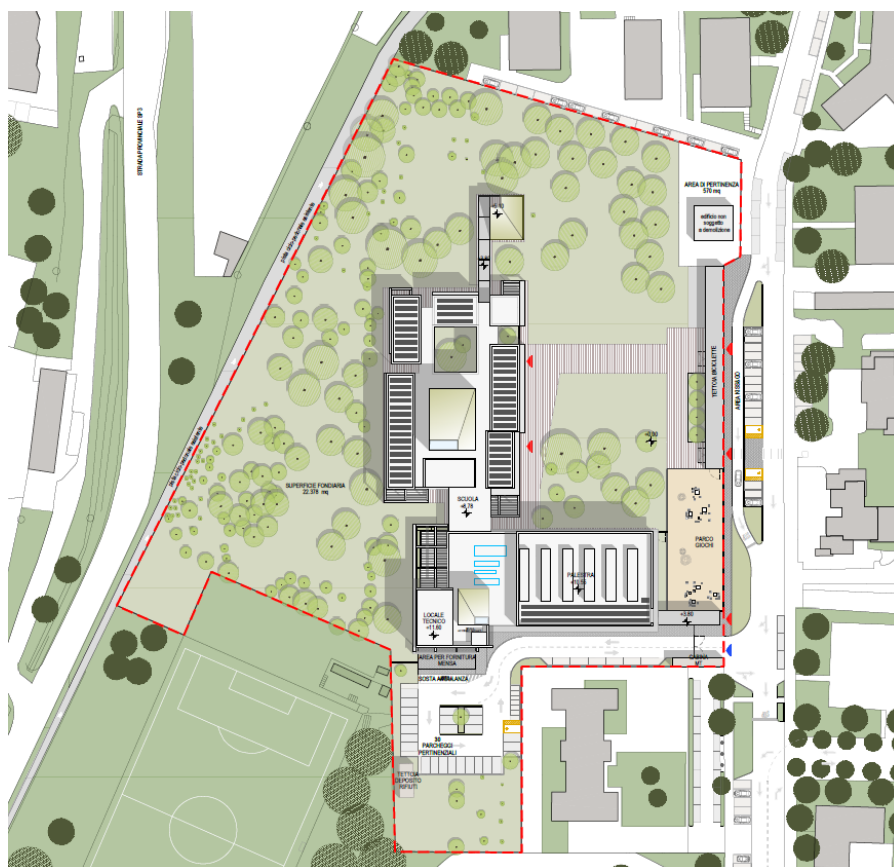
Planimetria della soluzione di intervento del 2022 precedente all'ottimizzazione
